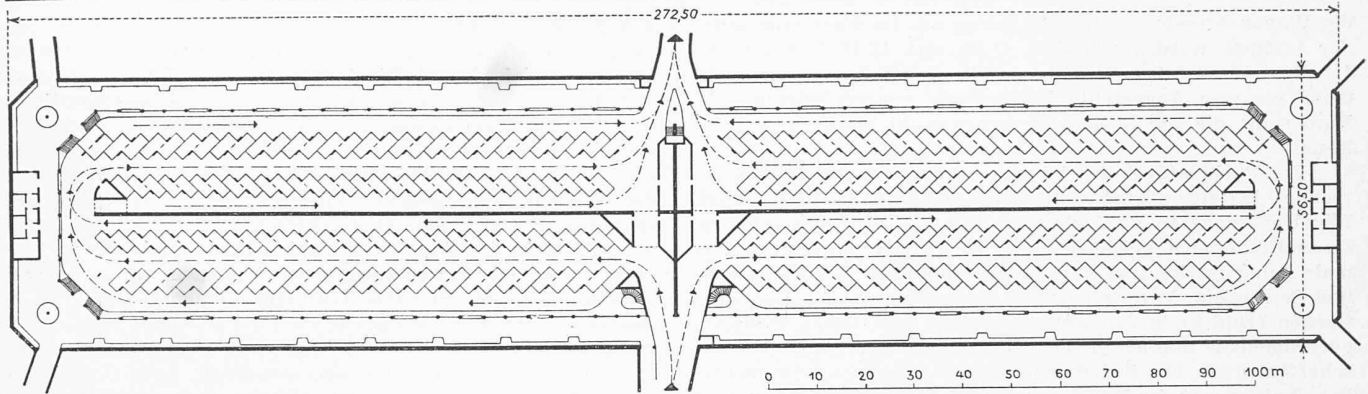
Parkgarage in der Limmat in Zürich nach Projekt von Arch. W. NAEGELI; Grundriss 1:1500
